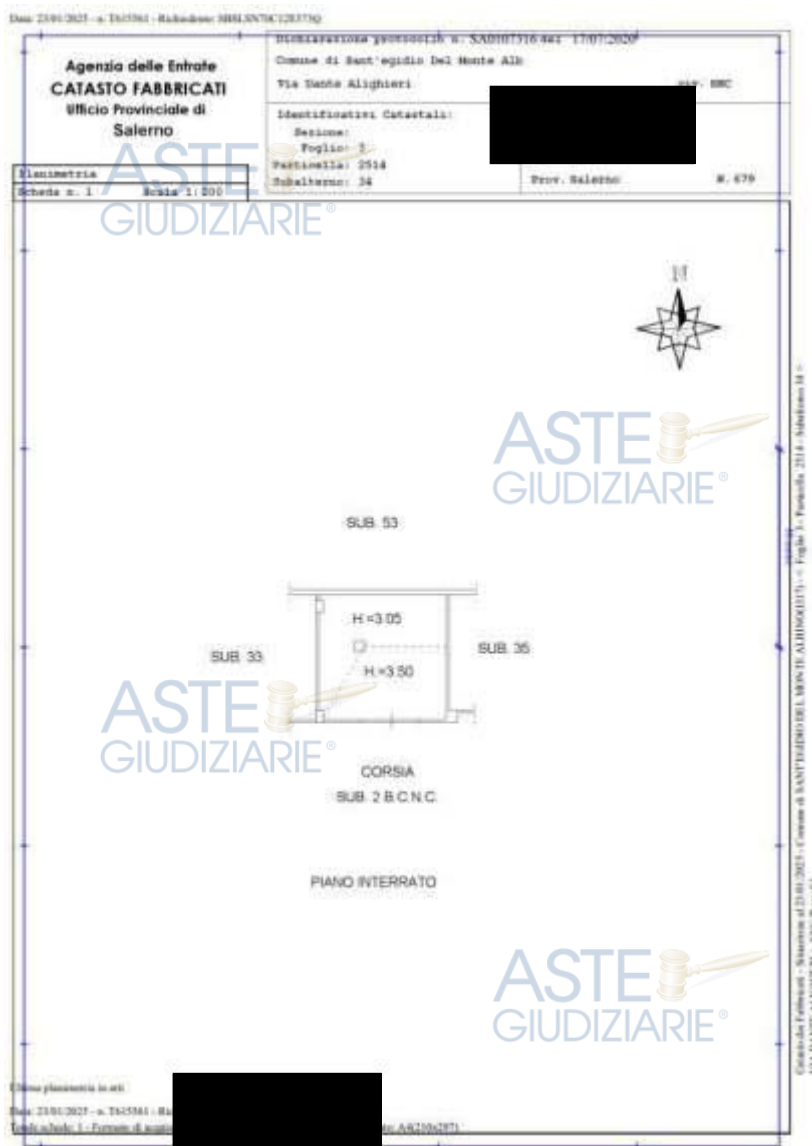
Planimetria catastale compendio pignorato lotto 7
